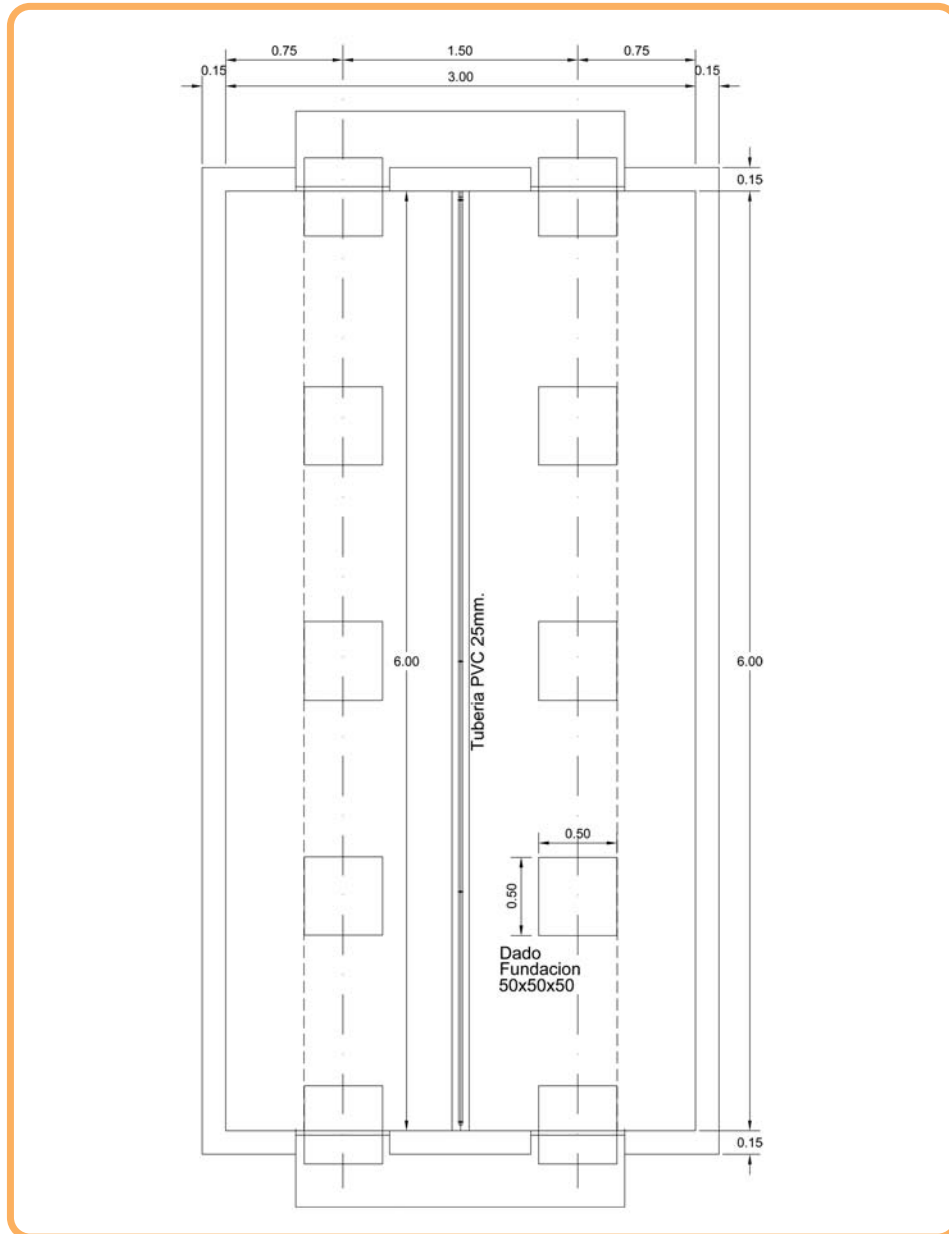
a) Vista de planta con las fundaciones y drenaje
